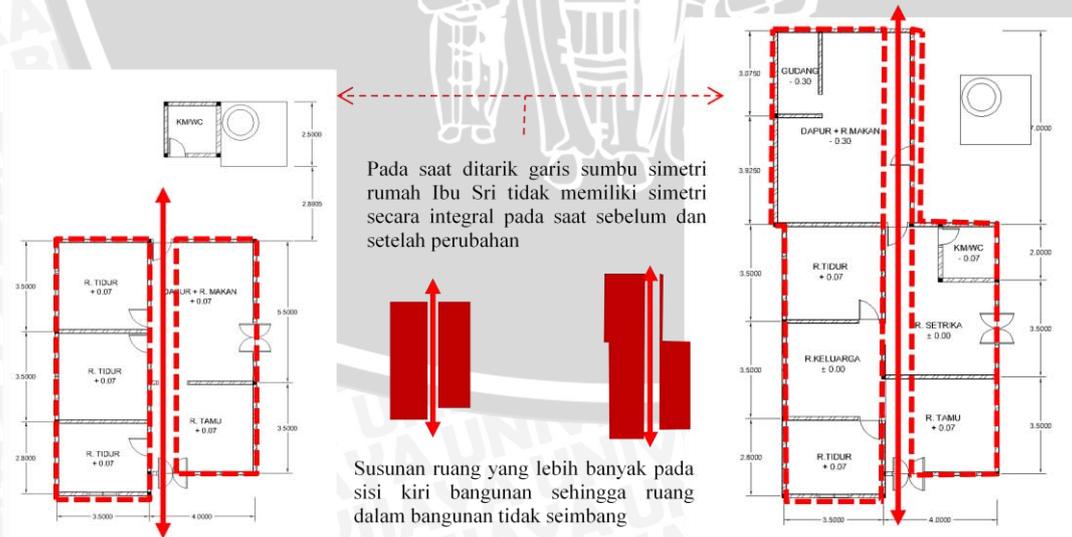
77 Denah dan pola ruang akhir rumah Ibu Sri
